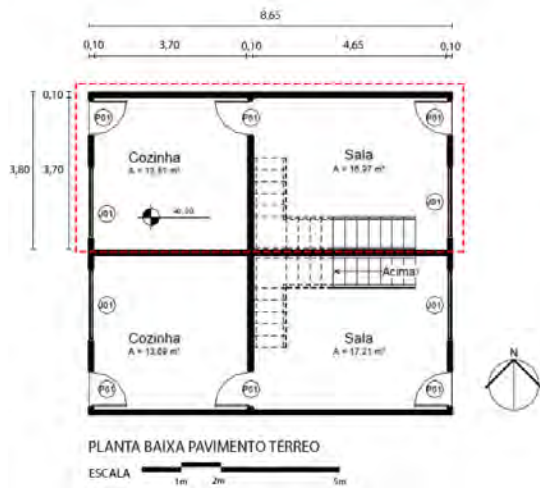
Planta baixa do pavimento térreo da edificação de referência.
